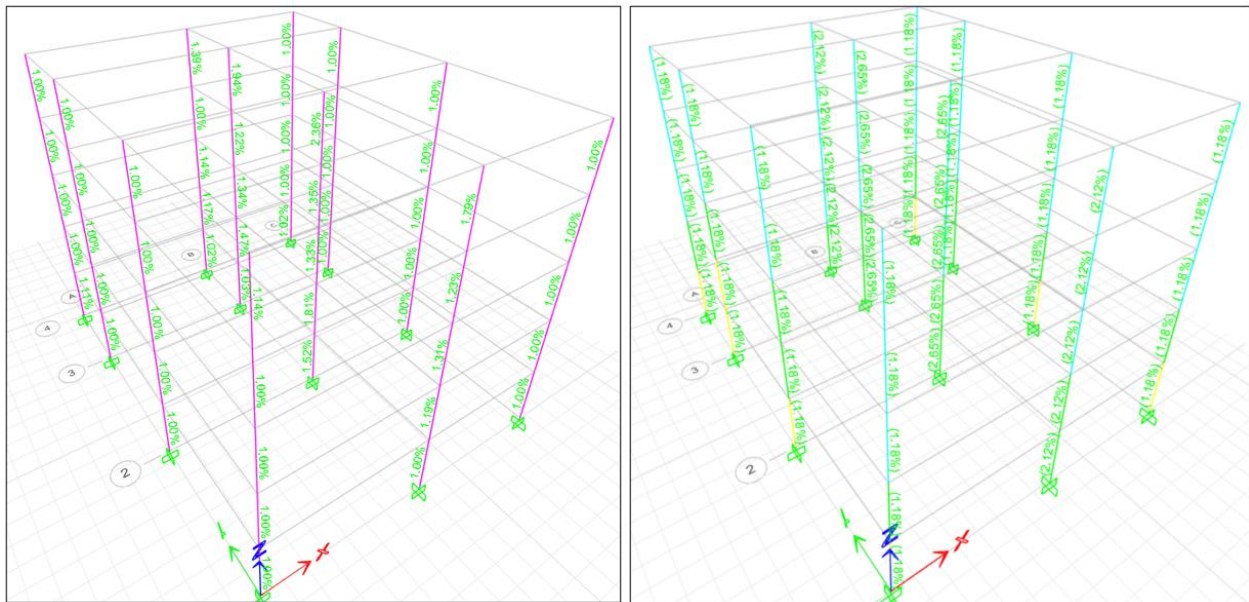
Configuración diseño columnas ETABS®. Fuente: Propia
